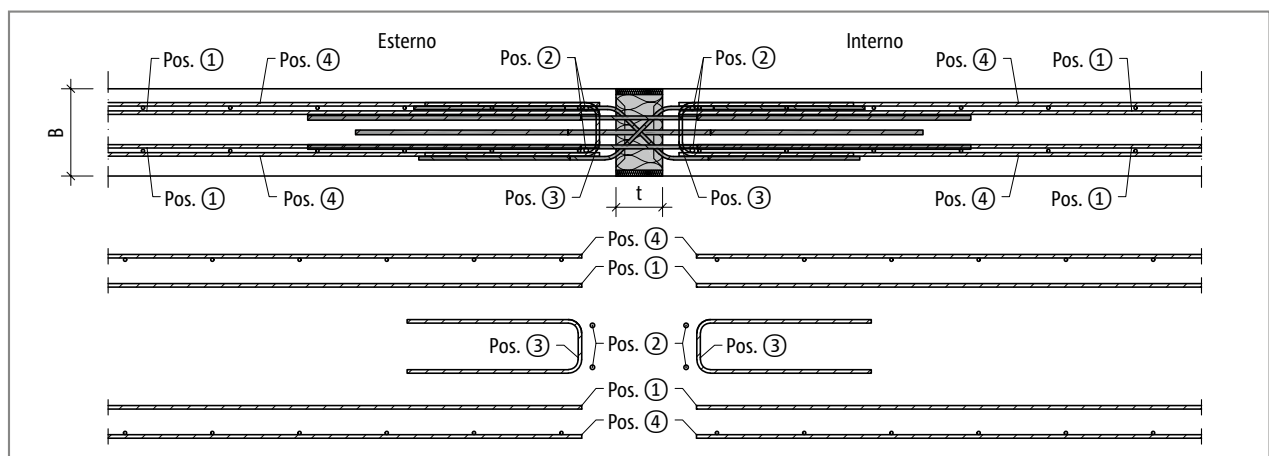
Schöck Isokorb® T tipo WL: armatura in opera; pianta
